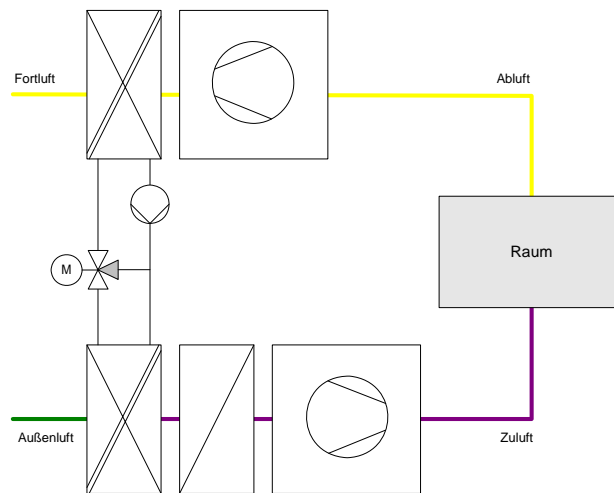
Schema eines kreislaufverbundenen Wärmerückgewinners
